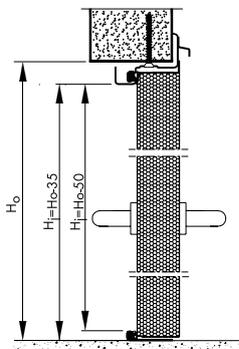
Montage einflügeliger Türen mit Eckzarge an der Stahlkonstruktion - Vertikalschnitt.
